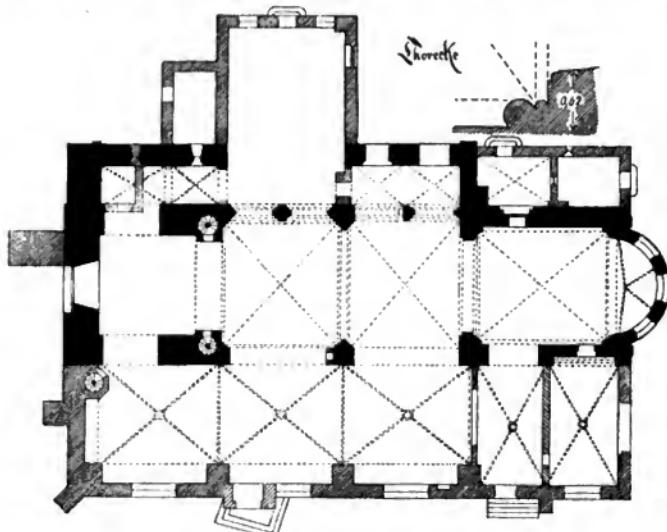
Grundriss der Kirche. 1/50.
